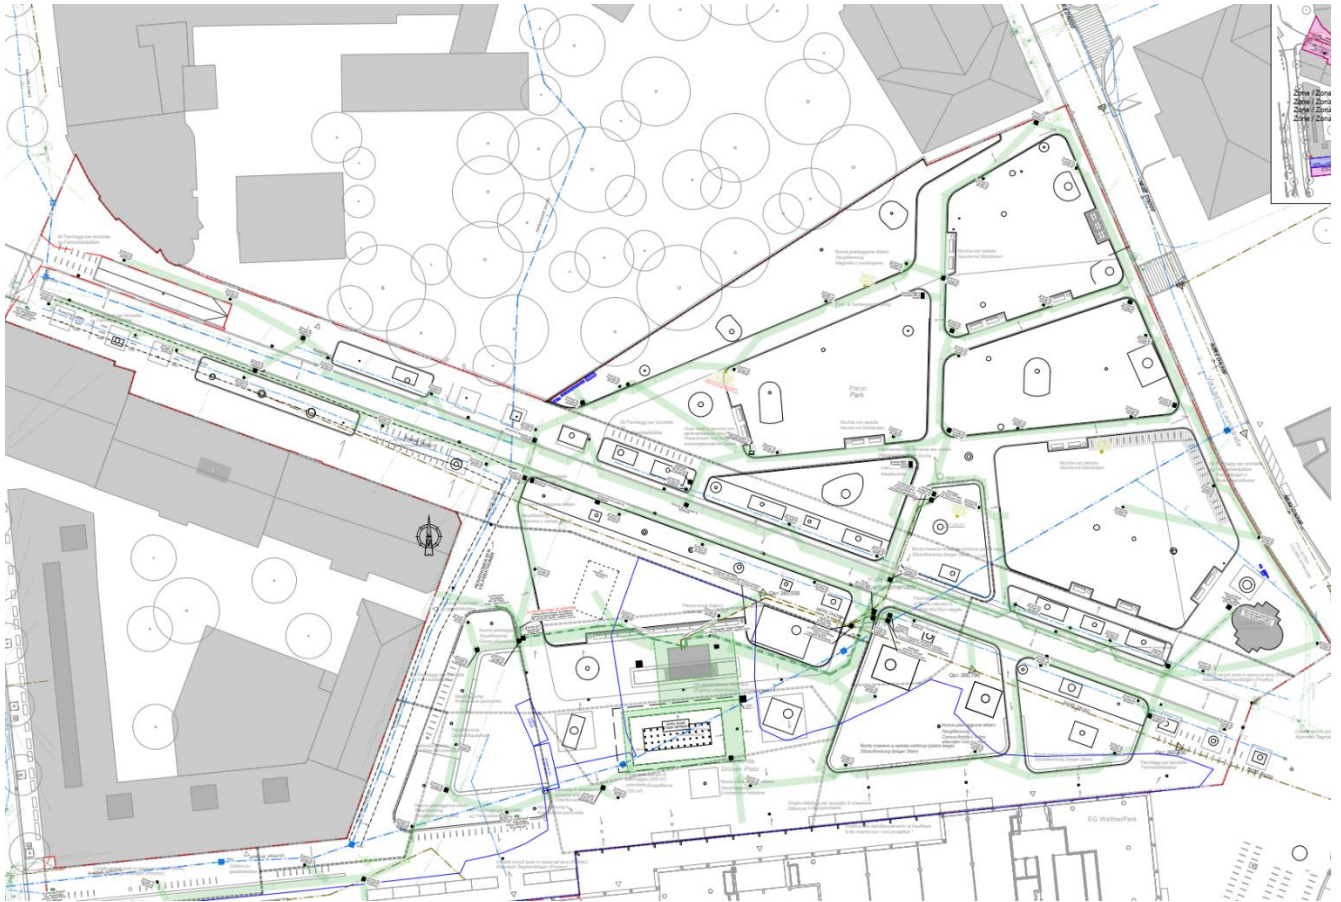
Grundriss der hydraulischen Anlagen
